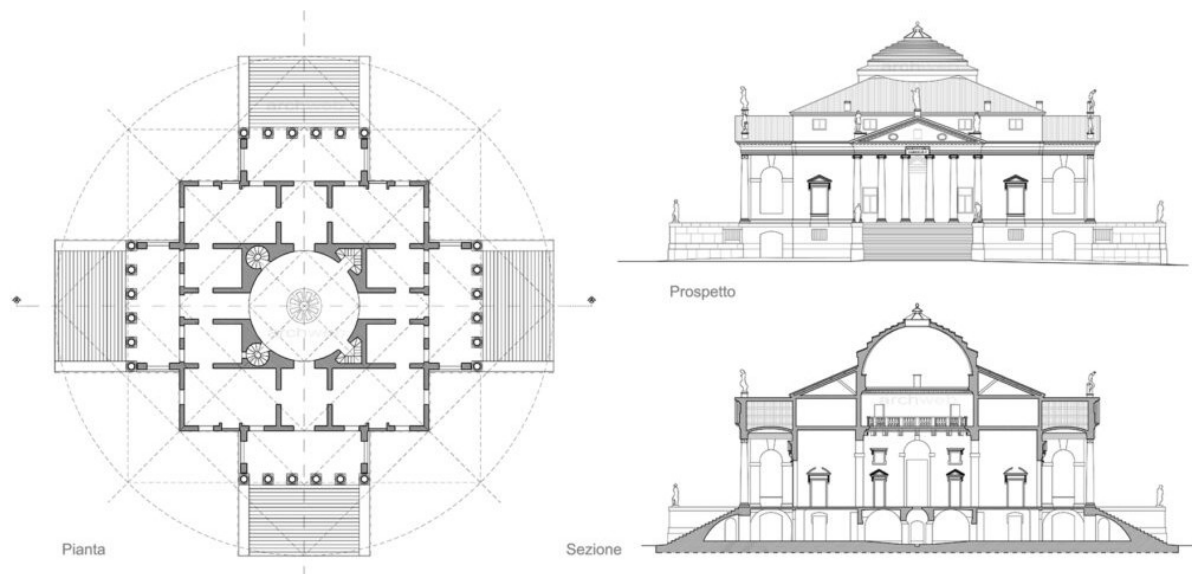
Figure XXV: La villa Capra (Rotonda), Vicence, 1566_1571. Plan coupe, façade.
